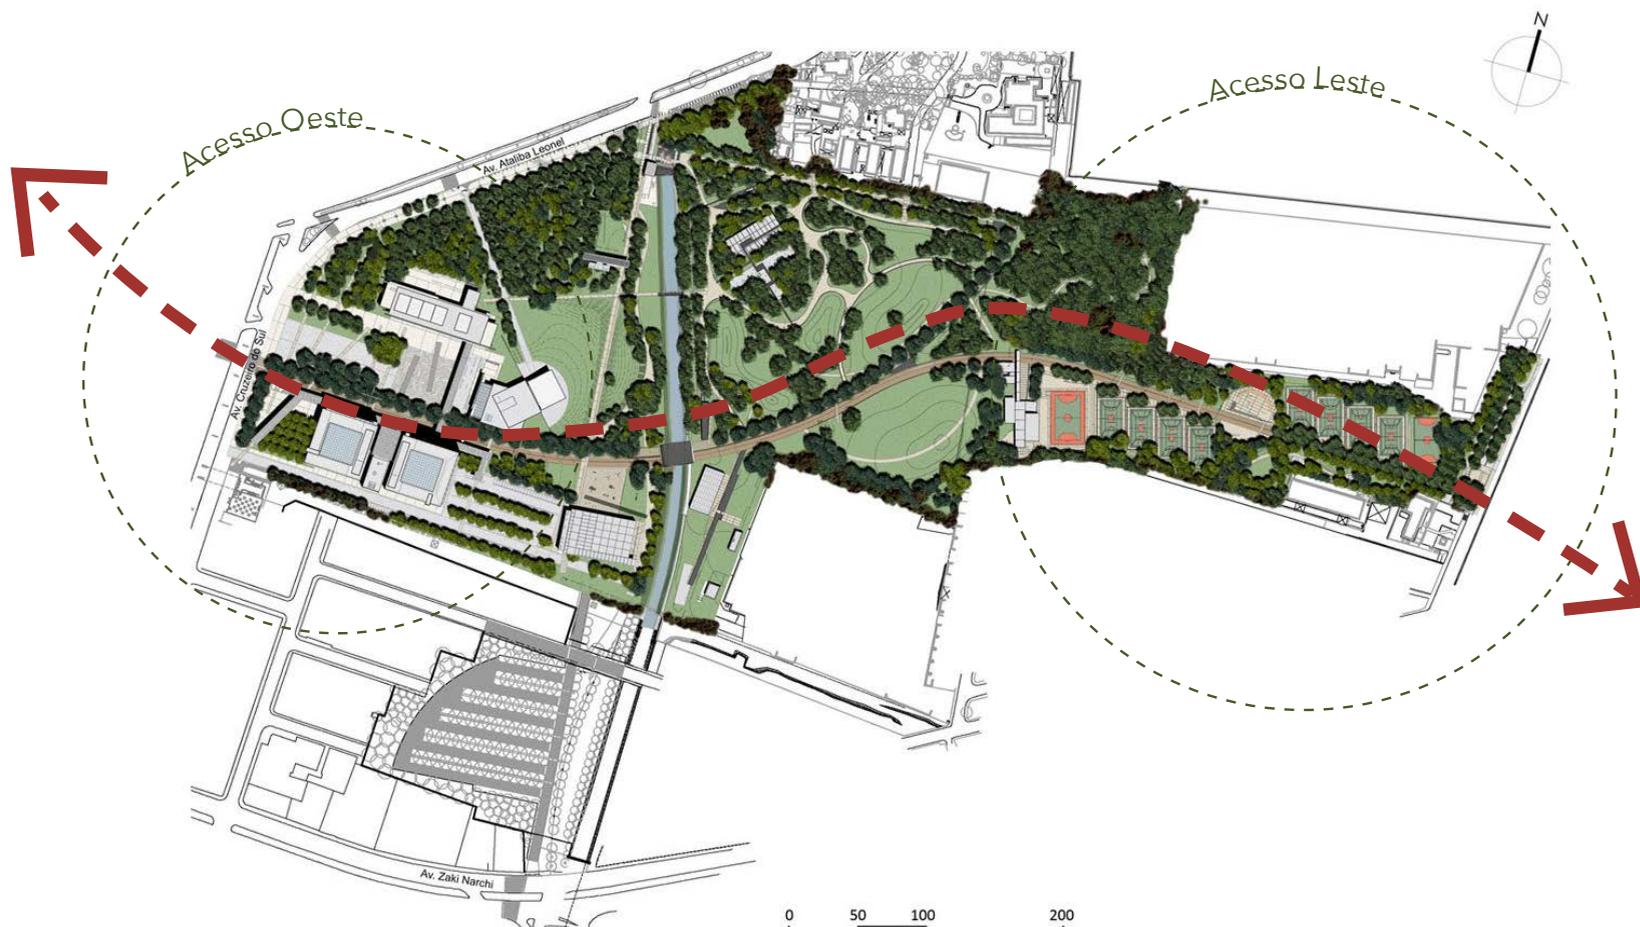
Planta baixa projeto - Afaló|Gasparini arquitetos
